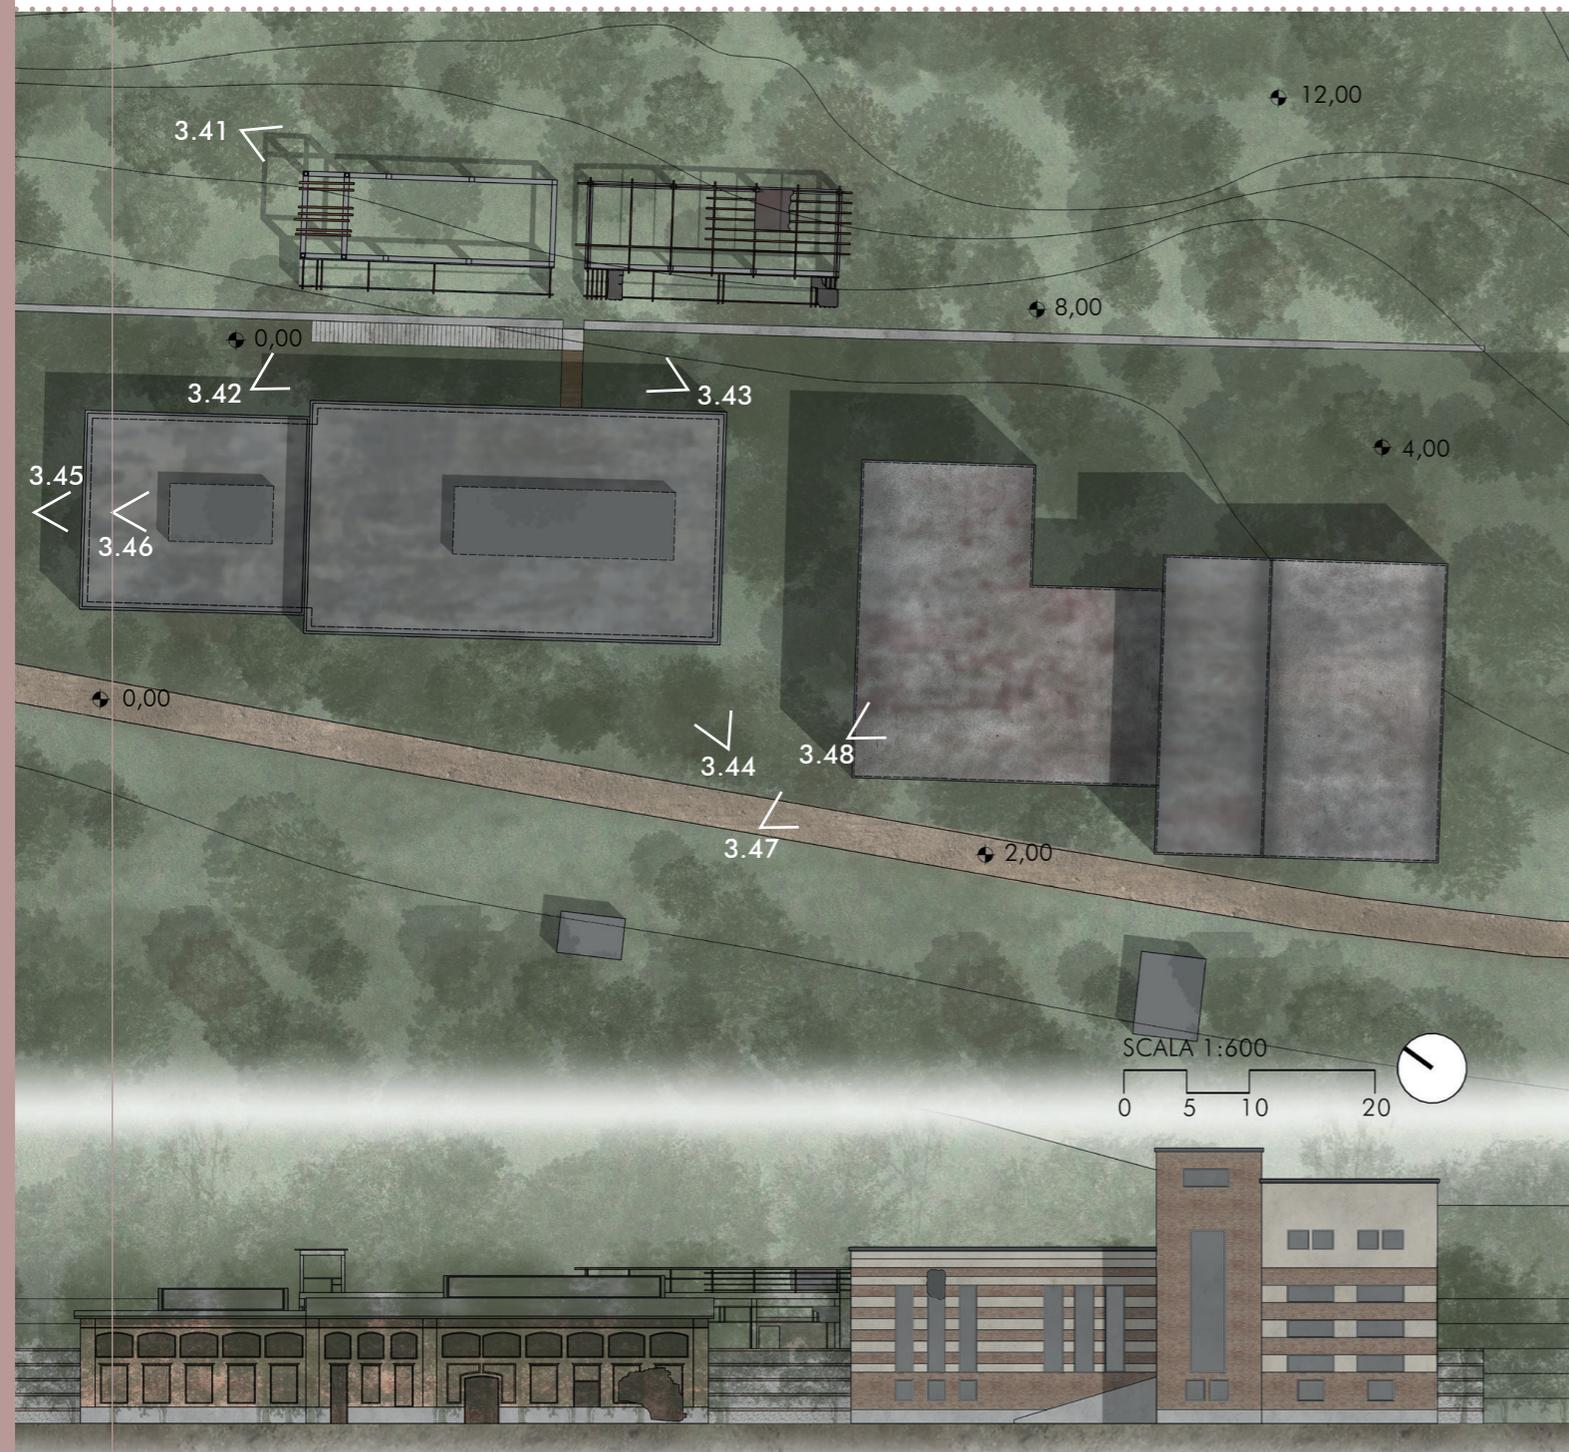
Planimetria e prospetto principale del quarto polo, stato di fatto, elaborazione dalle autrici
